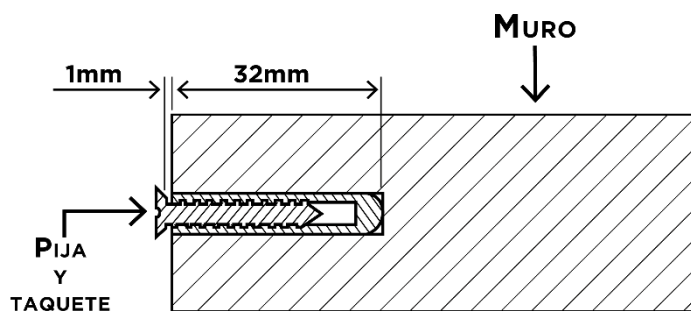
Diagrama transversal de muro con kit de montaje instalado.
